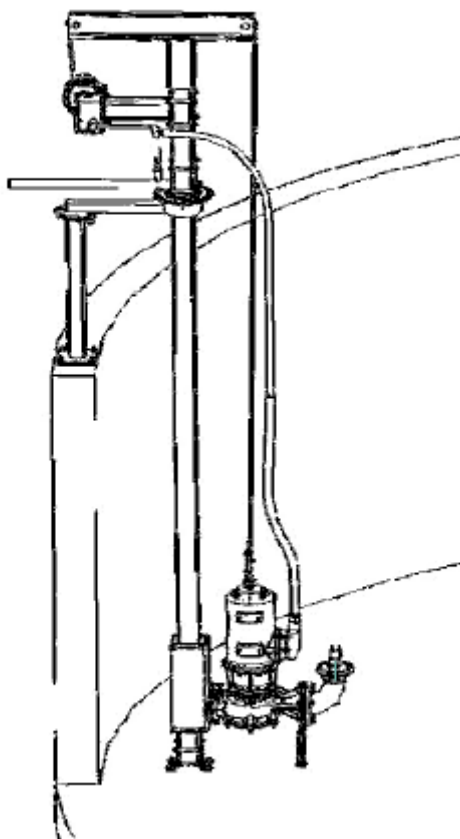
Suspensão da bomba apenas por meio do suporte pré-montado
